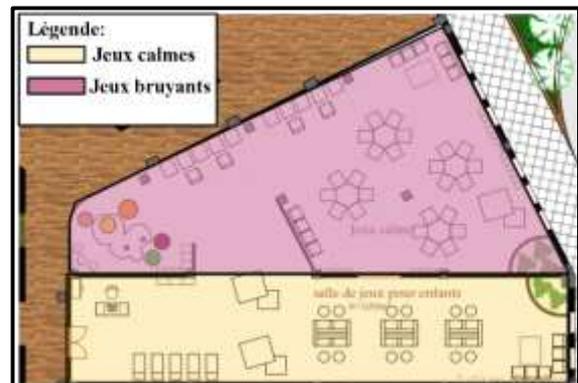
Plan de salle de jeux d'enfants (Source : l'Auteur)
